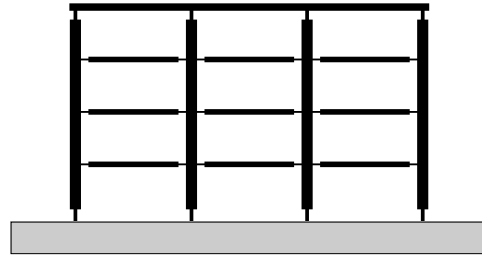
Les rotules plastiques doivent être disposées de préférence dans les traverses des cadres à étages multiples.
